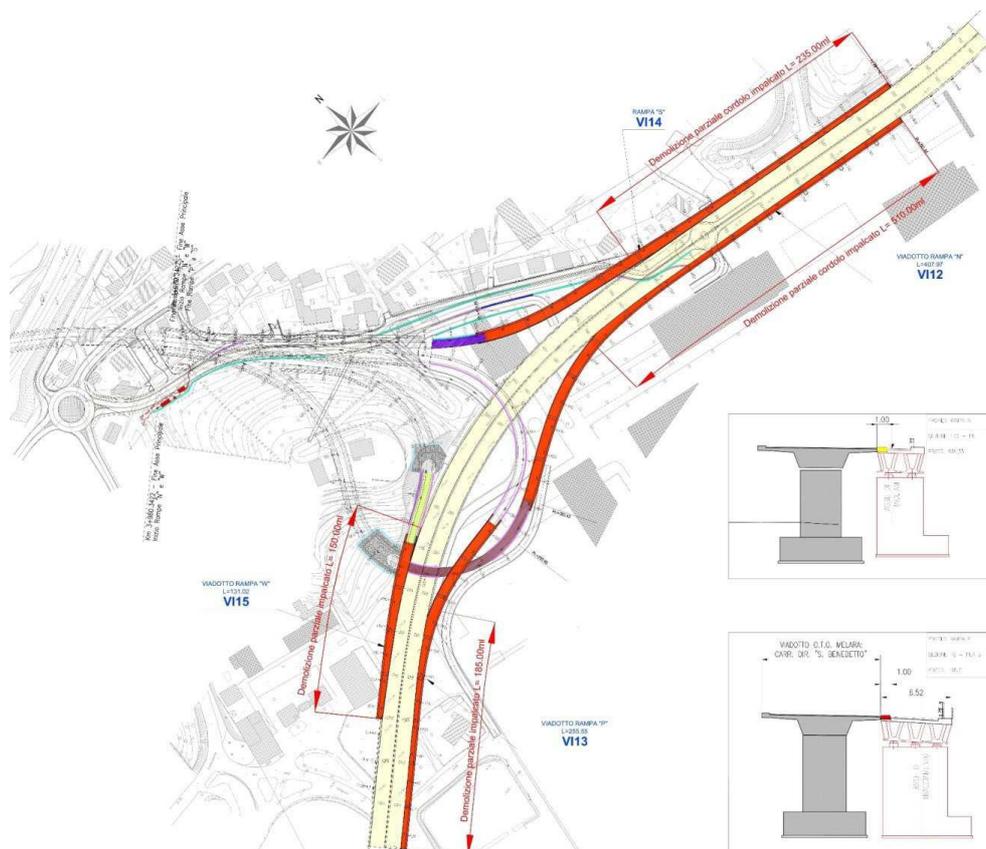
Stralcio planimetrico Viadotto Svincolo Melara
